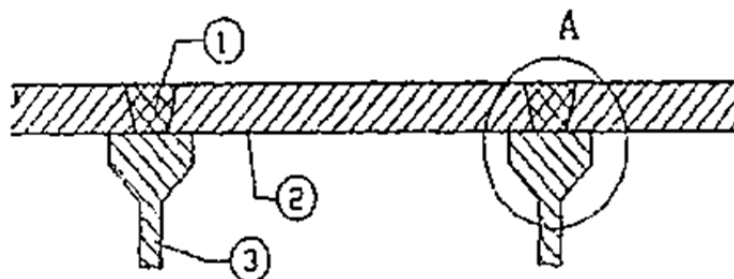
Ausführung von Plattenbalken mit Fertigteilen: (1) Ortbetonverbindung, (2) Fertigteilplatte, (3) Fertigteilträger<sup>20</sup>
